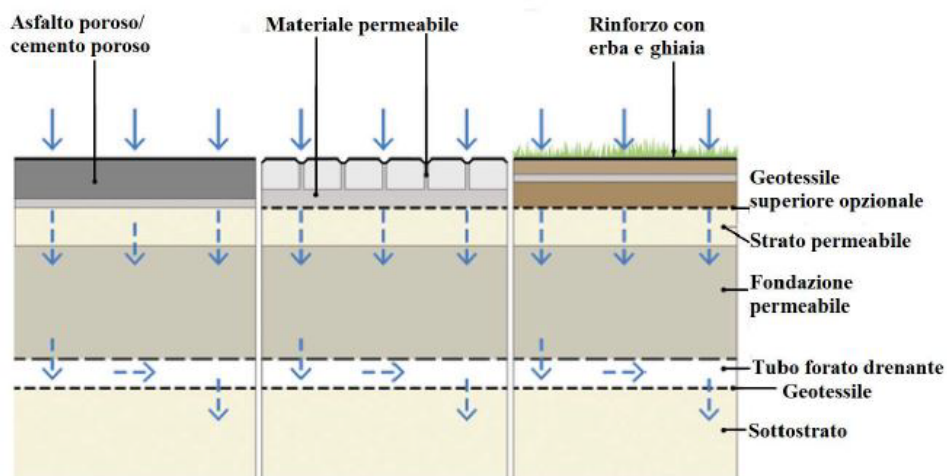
Rappresentazione di un sistema di pavimentazione permeabile (Woods Ballard et al., 2015)
